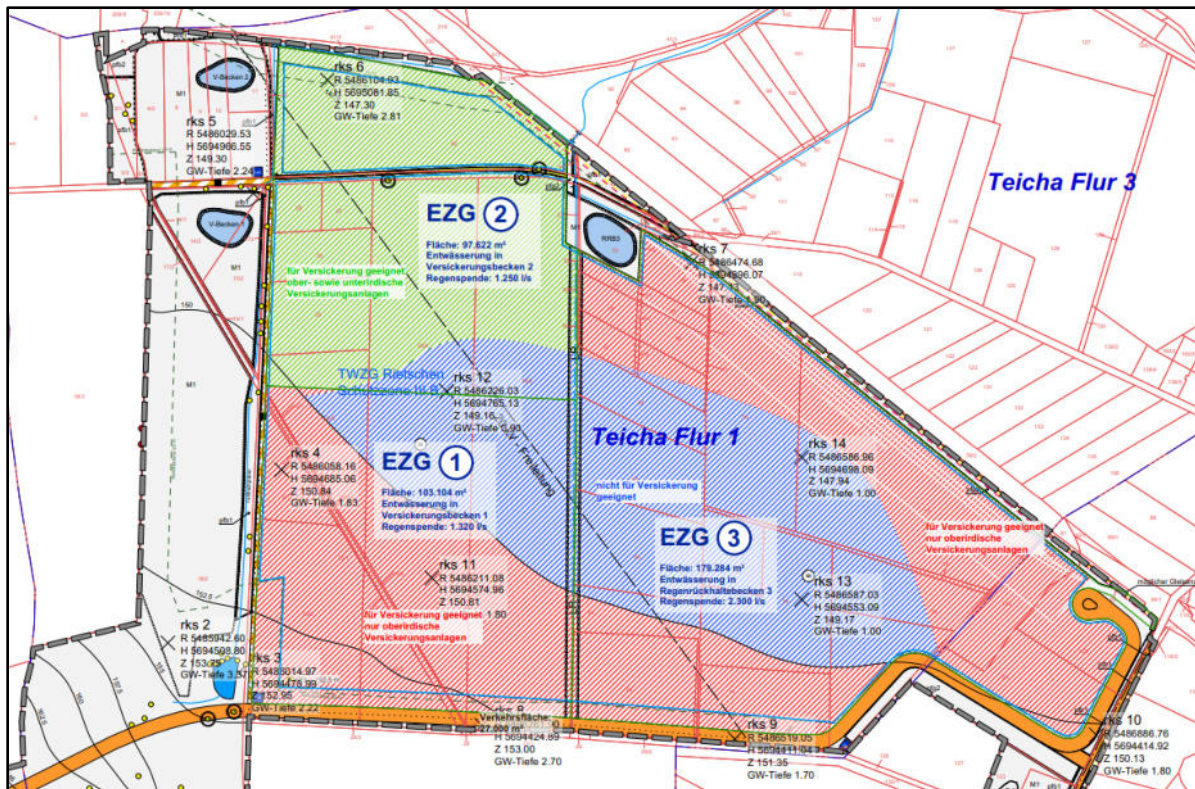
Lageplan mit versickerungsgerechten Flächen (EZG 1- EZG 3)
